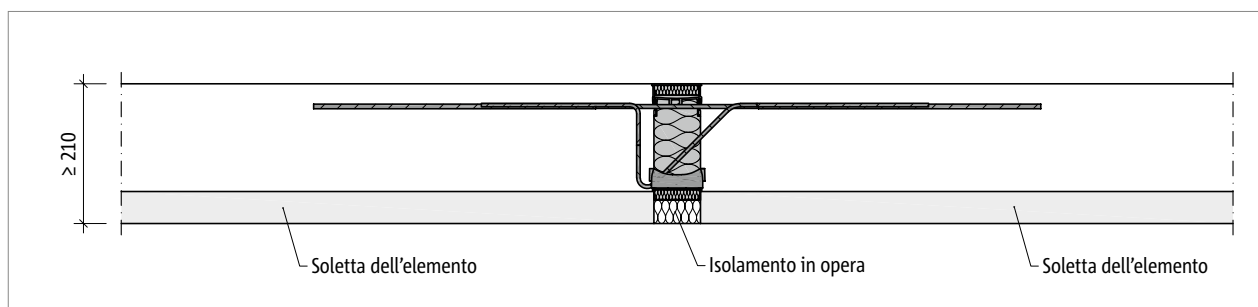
Schöck Isokorb® T tipo KL: solaio prefabbricato con Isokorb® T tipo KL sovrapposto
